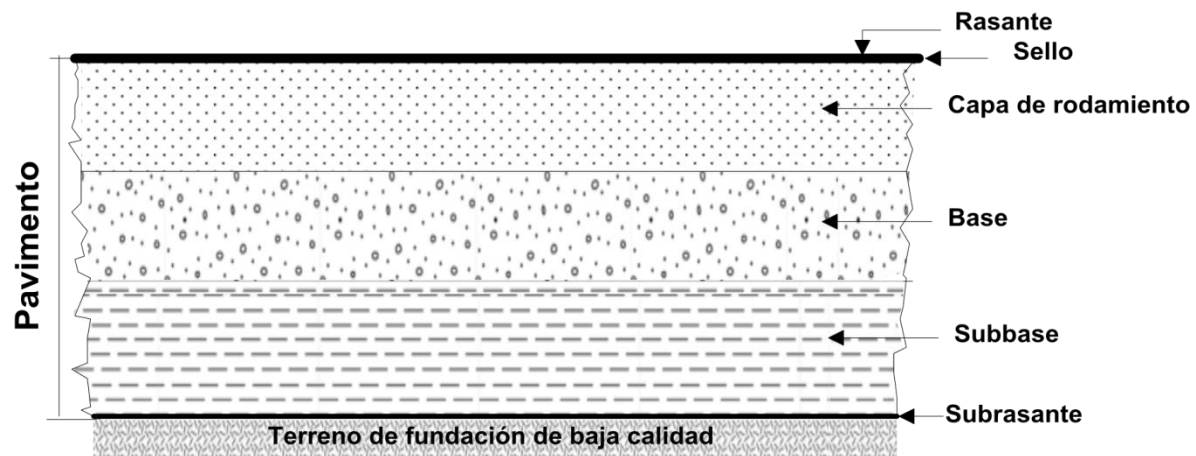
Sección de pavimento flexible para un terreno de fundación de baja calidad (Valle Rodas, 1975).
